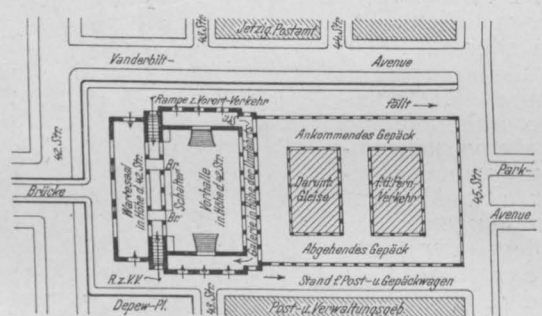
Grundrißskizze des Empfangsgebäudes in Höhe der Umfahrtsstraßen nach dem endgültigen Plan.
